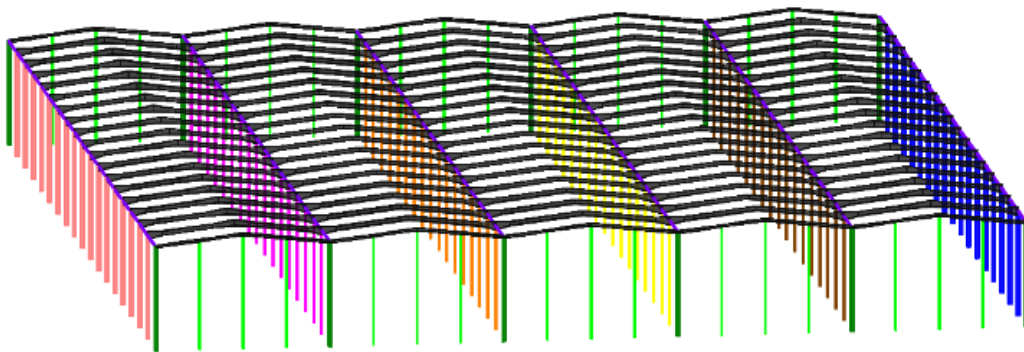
Modelo da estrutura principal em “portal frame”
